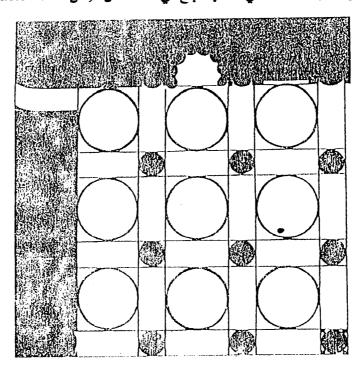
مسقط أفقي لمسجد القلعة بأرضروم أواخرق ٦هـ/١٢م وأوائل ق٧هـ/١٣م (عصر السلطقيين) ـ (عن : آصلان آبا).
